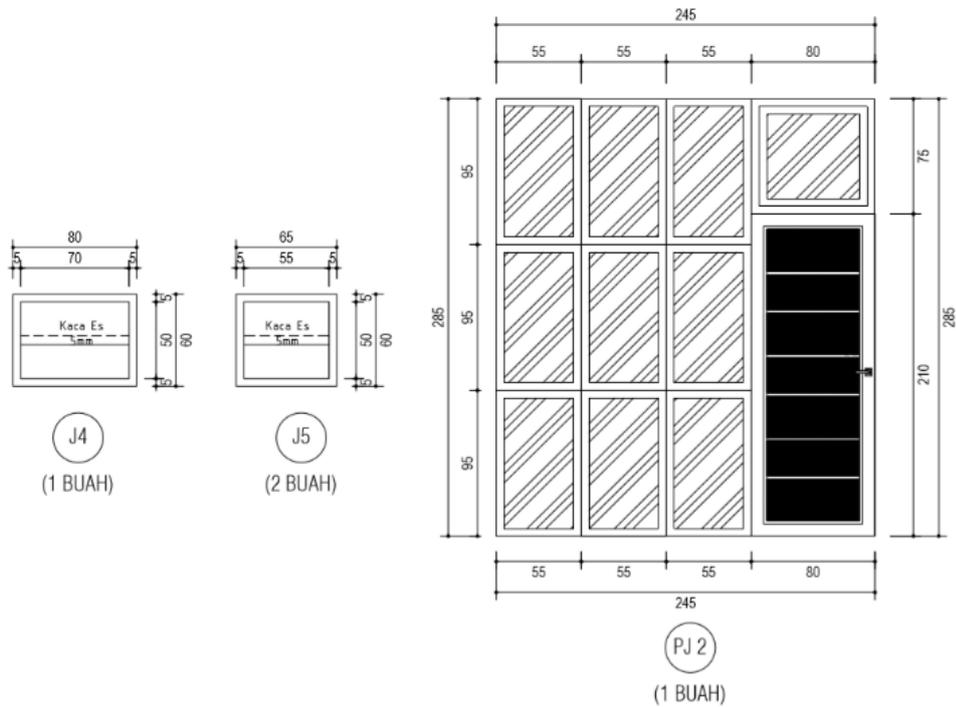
16 DENAH KUSEN LT.ROOFTOP
